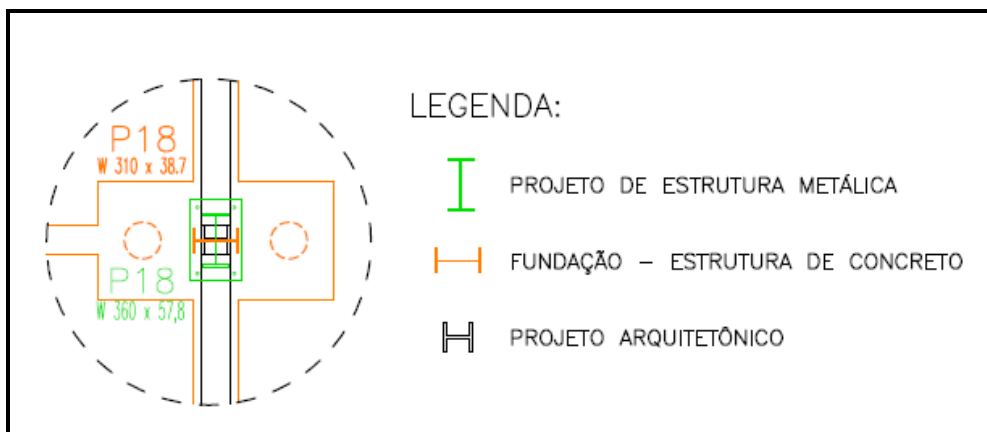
Divergência na representação do mesmo pilar extraído dos projetos: Estrutura Metálica, Estrutura de Concreto e Arquitetônico.
